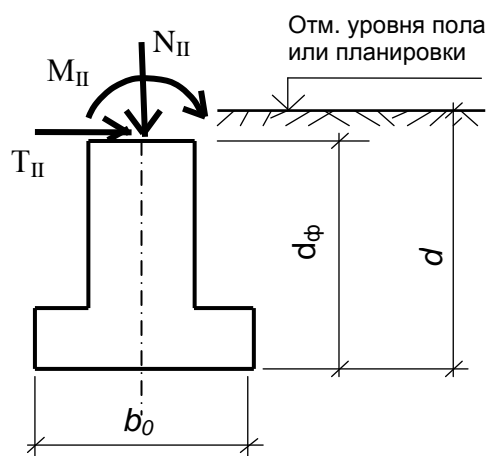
Предварительная расчетная схема фундамента на естественном основании
